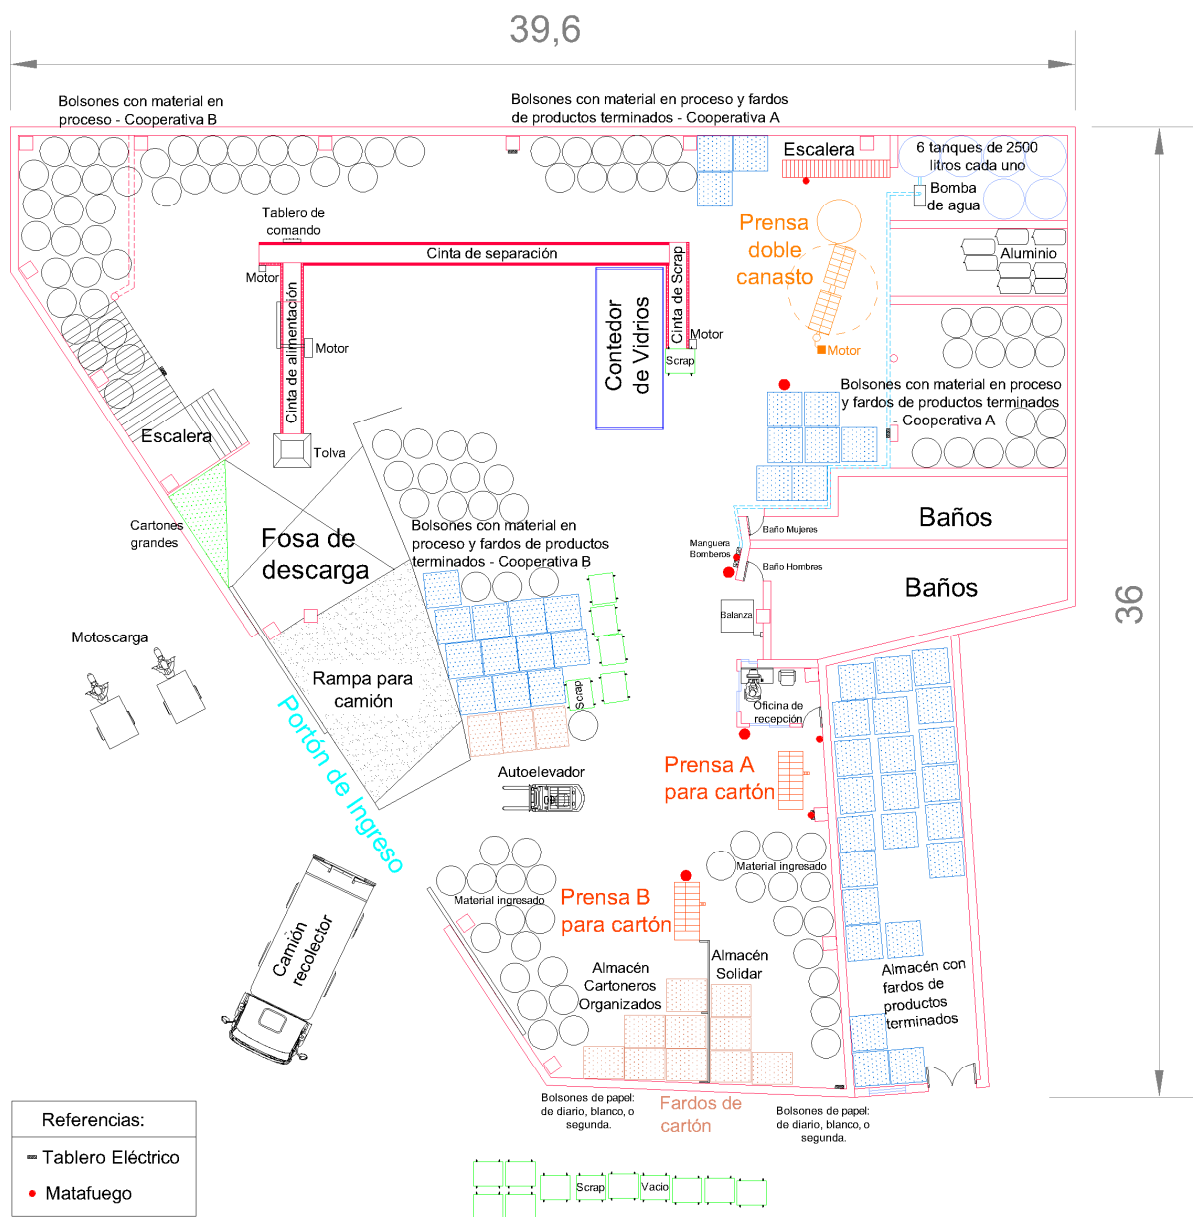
Lay Out Centro Verde Tillard planta baja.
